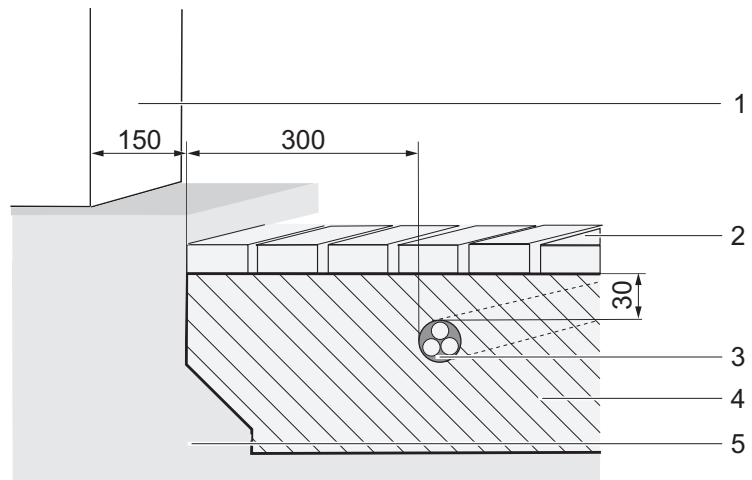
Placera induktionsslingor i bitumen, asfalt eller betong (mått i mm)
